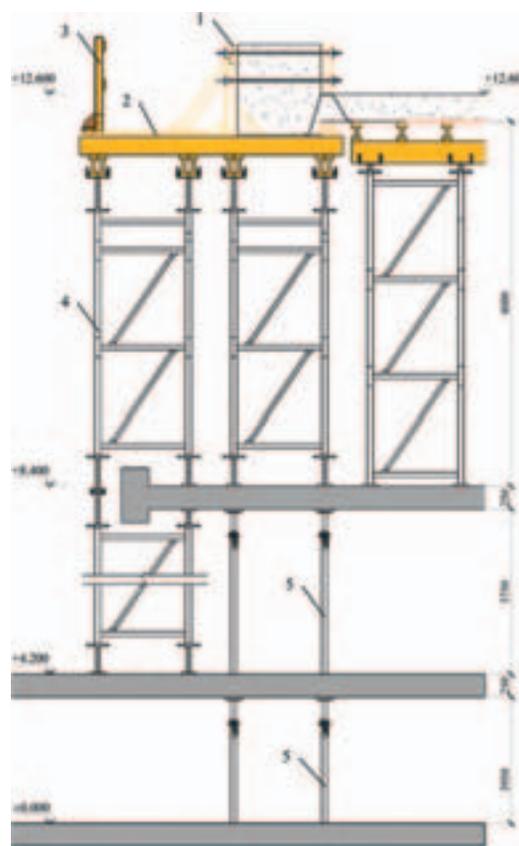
Схема опалубки обвязочной балки и монолитного перекрытия на отм. +12,600 центрального ядра высотного книгохранилища:
